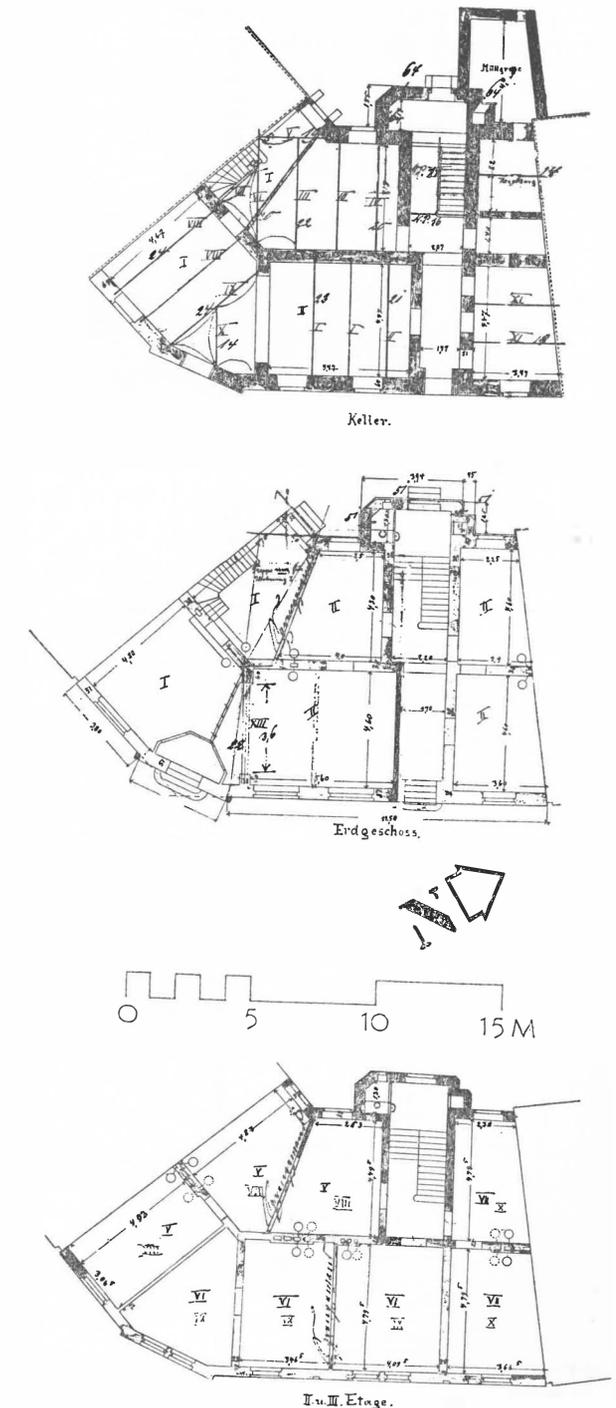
Grundrisse des Arbeiter-Wohnhauses an der Ecke Bärenstraße-Königstraße
